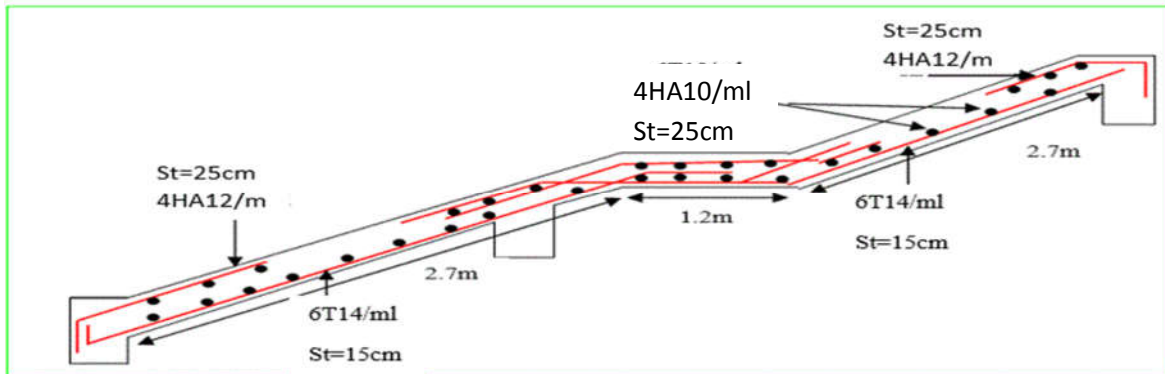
Schéma de ferrailage de l'escalier type 1
